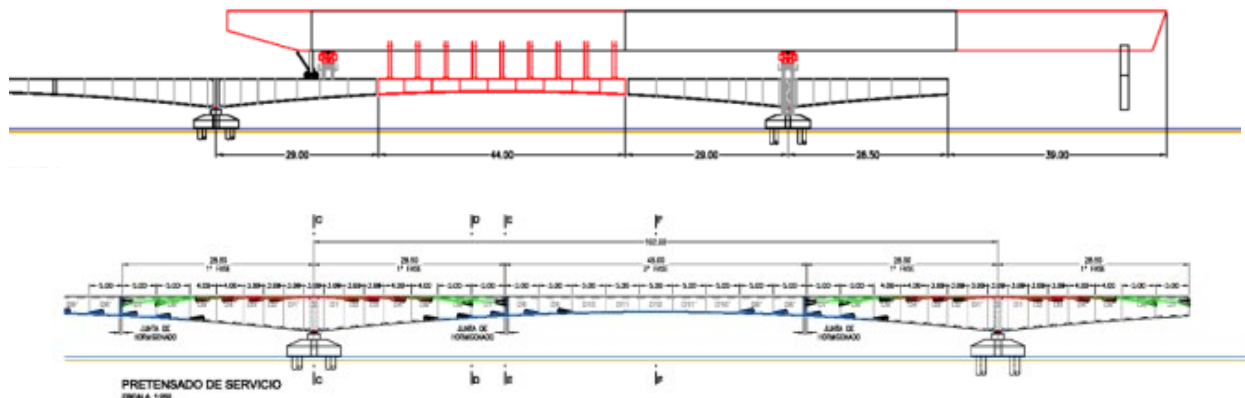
Secuencia de la ejecución del segundo tramo en la zona central
